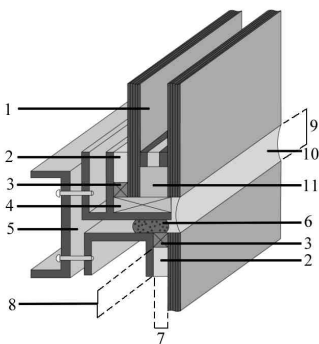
A: Detail dwarsverbinding. Voorbeelden van structurele beglazingsontwerpen: 4-zijdig ontwerp (in de fabriek beglaasd).
